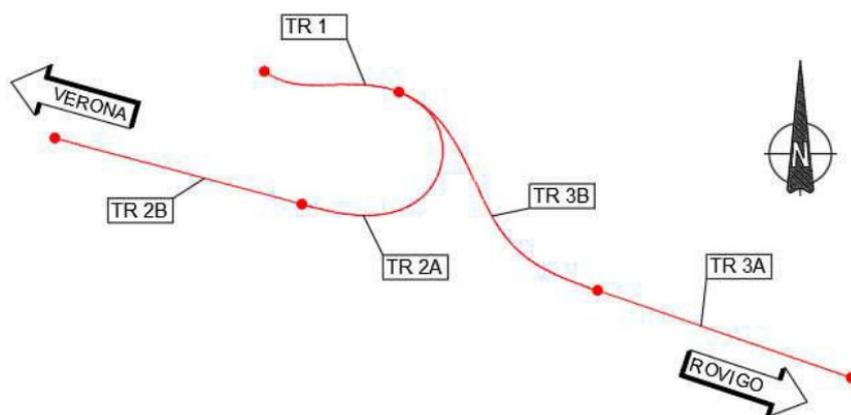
Layout dell'intervento (Fonte: Documentazione di chiarimento)
